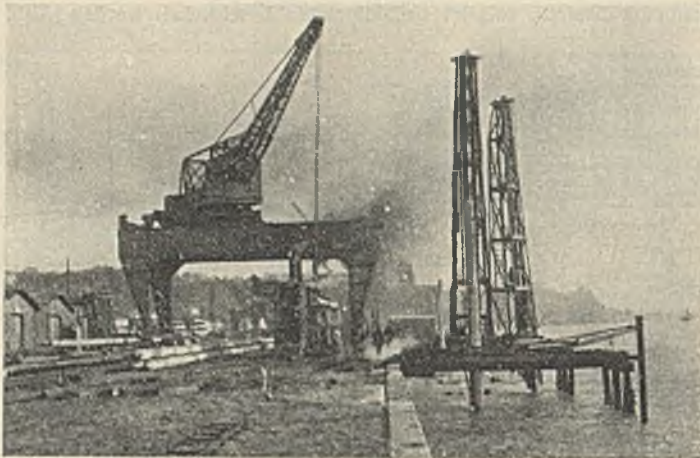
Das bewegliche Rammergerüst. Einschlagen eines Eisenbetonpfahles.
